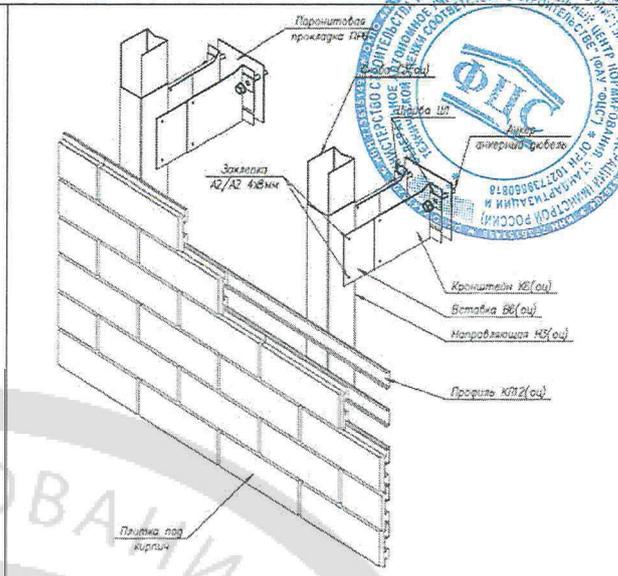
Система с облицовкой плиткой под кирпич на профиль КП12(оц) (крепление в межэтажные перекрытия)
